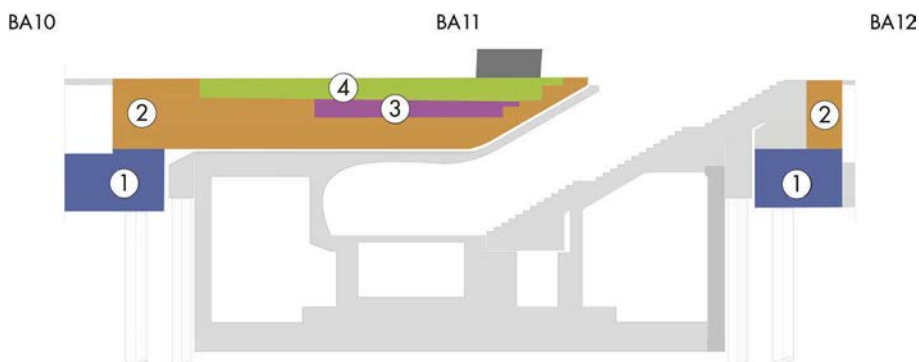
Betonierabschnitte des Brückenbauwerks: 1 Pfahlkopfbalken, 2 untere Betonierabschnitte, 3 bis OK Gleis, 4 bis OK Bahnsteig
